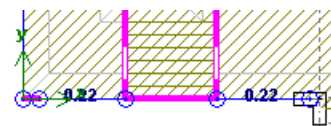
Плита перекрытия с нагрузкой (фрагмент)
